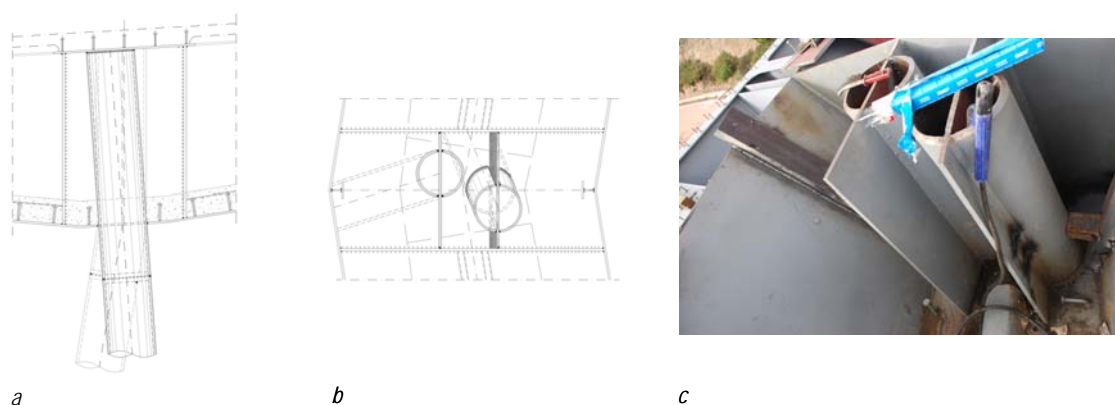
Diafragma de pila; a) Sección longitudinal; b) Vista en planta; c) Vista interior de la viga cajón durante la fabricación
